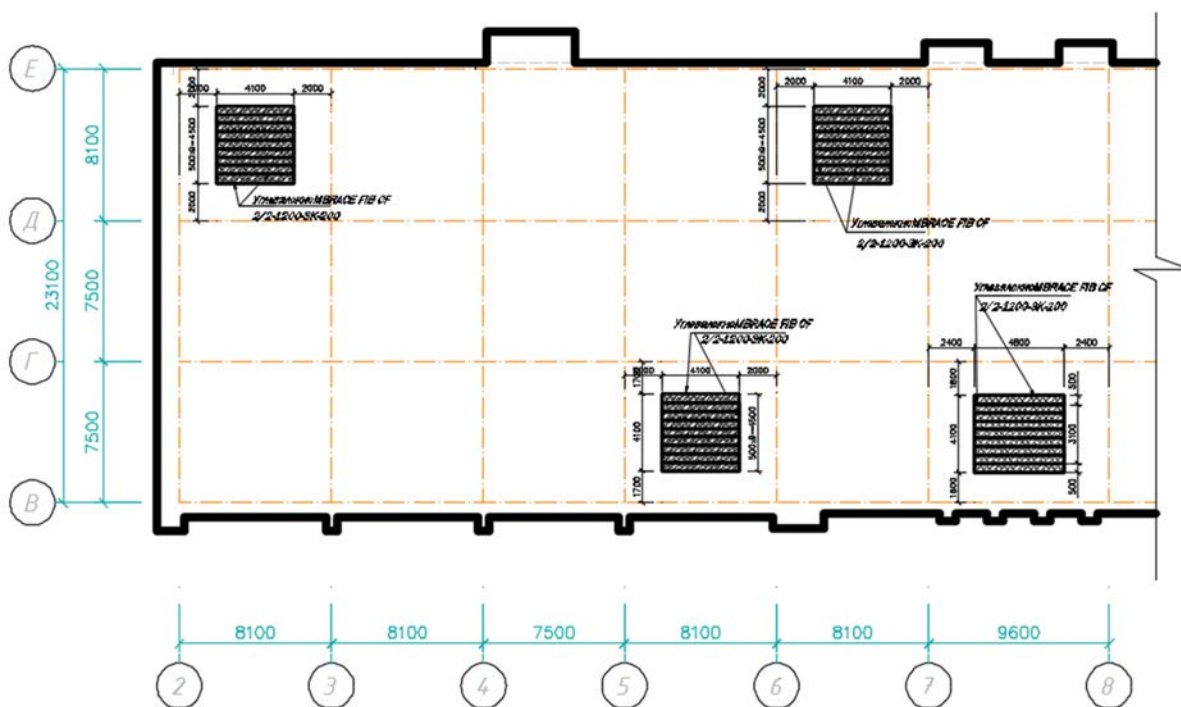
Схема расположения усиливающих сеток на плите перекрытия на отм. +18,000 здания на пр. Сейфуллина
